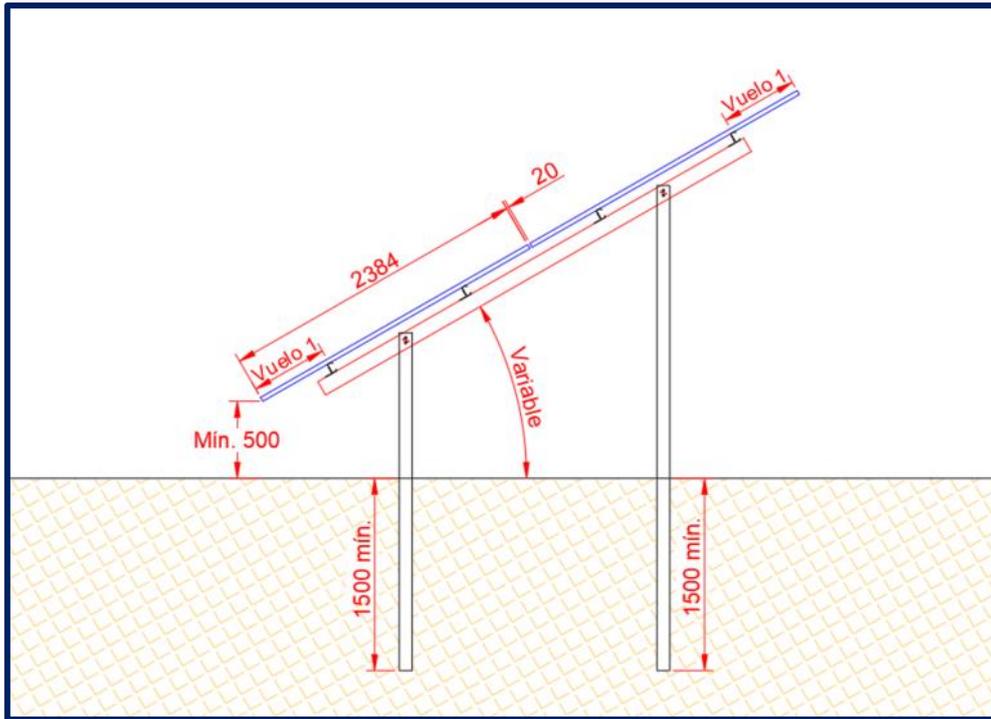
Dimensiones principales del pórtico de la estructura.
